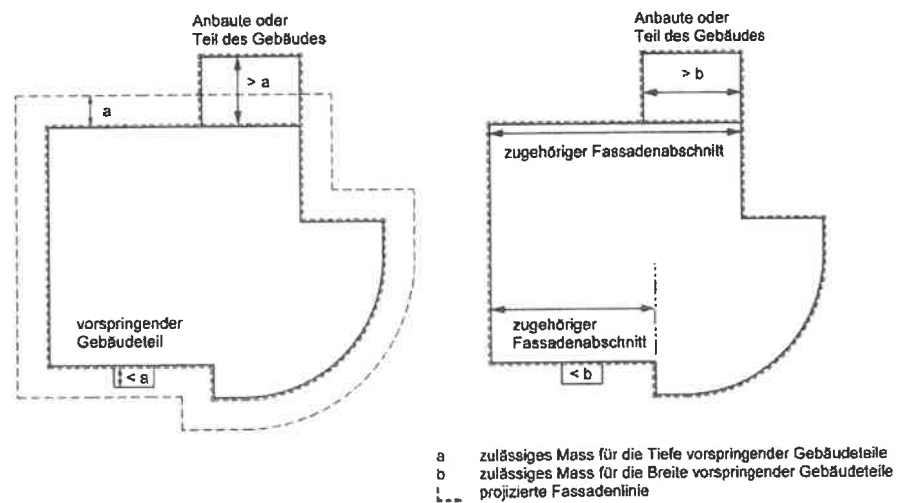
a Fassadenflucht und Fassadenlinie (in ebenem Gelände)
